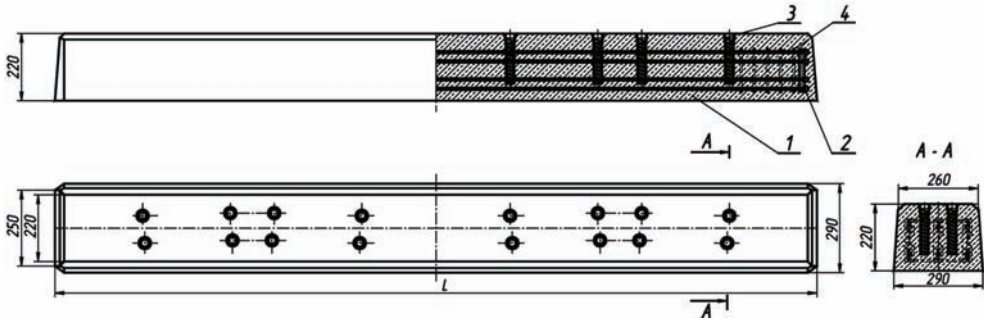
Podkład strunobetonowy PS93 dla przytwierdzenia SB-3, szerokości toru 1435 mm i szyn 49E1. 1 – beton; 2 – wiązka zbrojenia; 3 – kotwa przytwierdzenia SB-3 [9]
